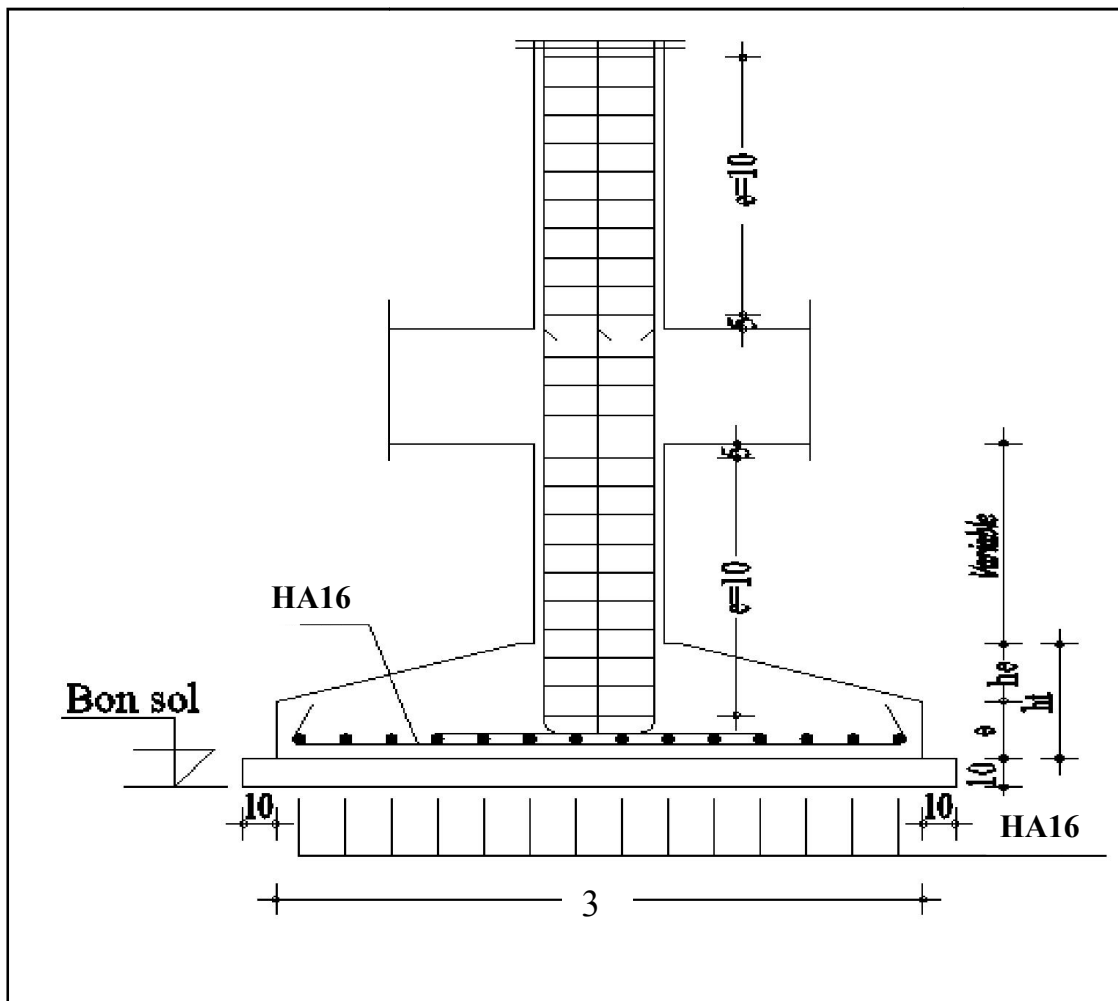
Schéma de ferrailage de semelle isolée
